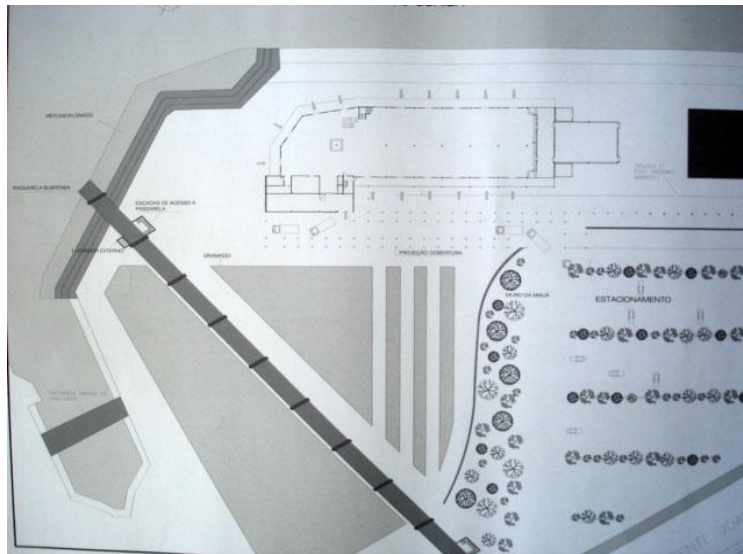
Pavilhão de Exposições. Planta do térreo do edifício e espaço aberto. Aluno: Rafael Lorentz. 2007.
